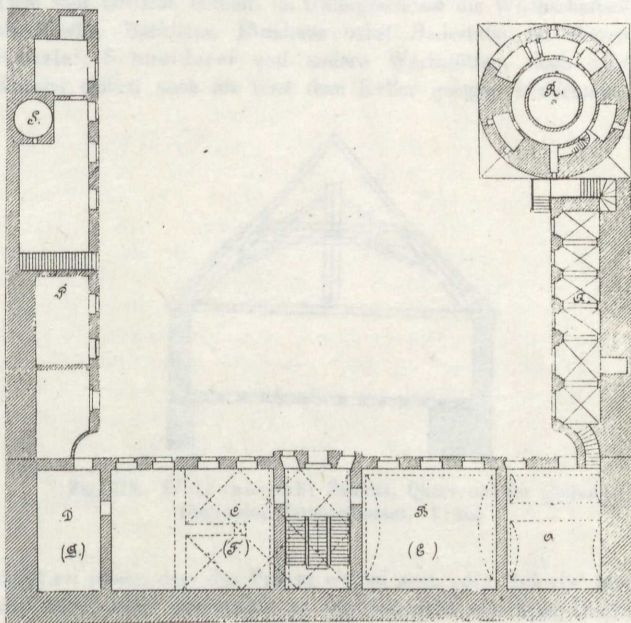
Wildenbruch; Schloss, Grundriss. 1:500.
